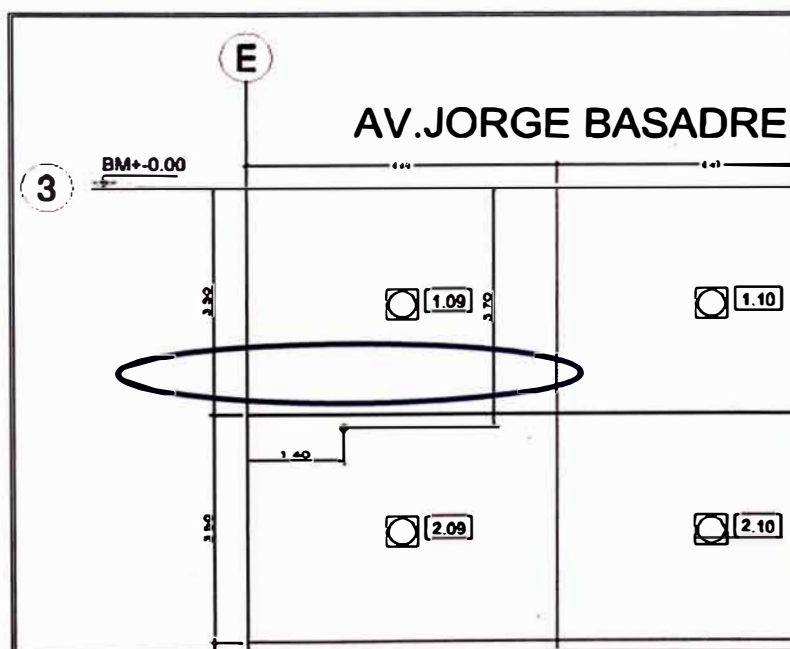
Extracción de testigo cilíndrico de concreto en zonas de unión de anillos de muro pantalla
